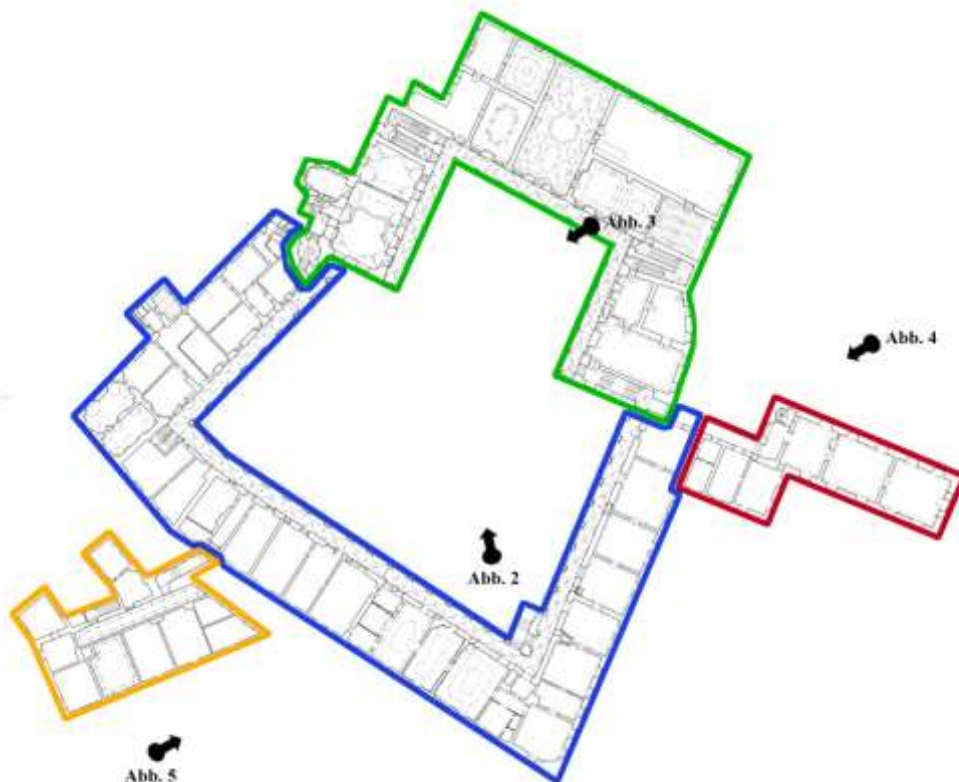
Markierung der einzelnen Teile des Schlosses im Grundriss des ersten Stockes⁵
